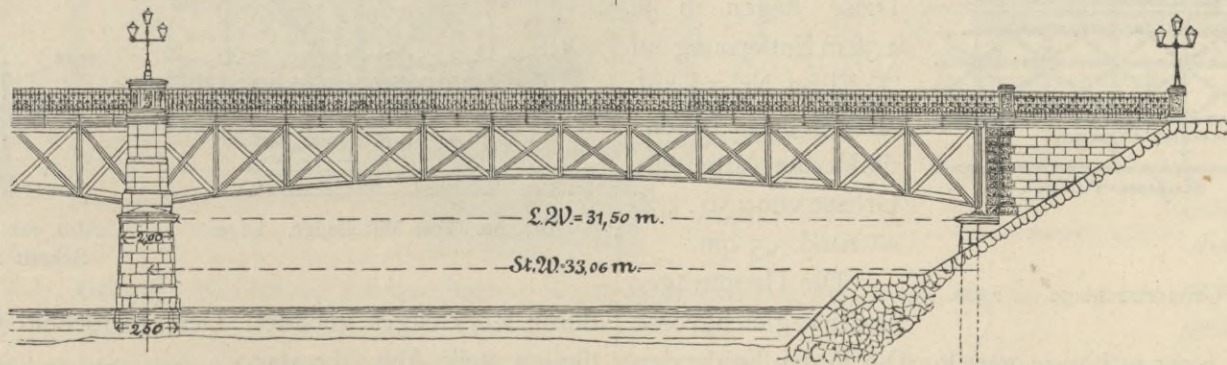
Ansicht einer Öffnung der Radetzky-Brücke und eines äusseren Hauptträgers. 1 : 300.
